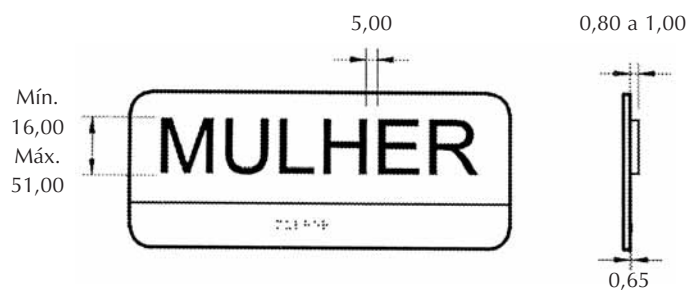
Sinalização tátil - vista superior e corte (dimensões em mm)
